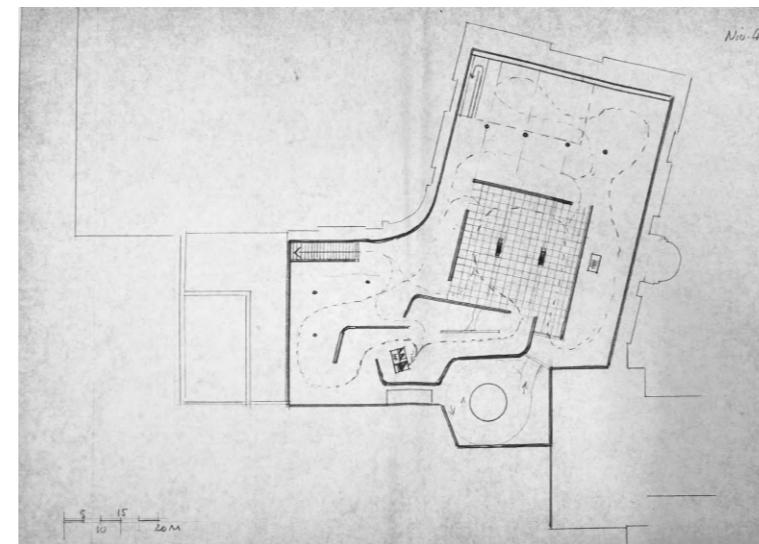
Plan R-3, 7^{ème} esquisse.
